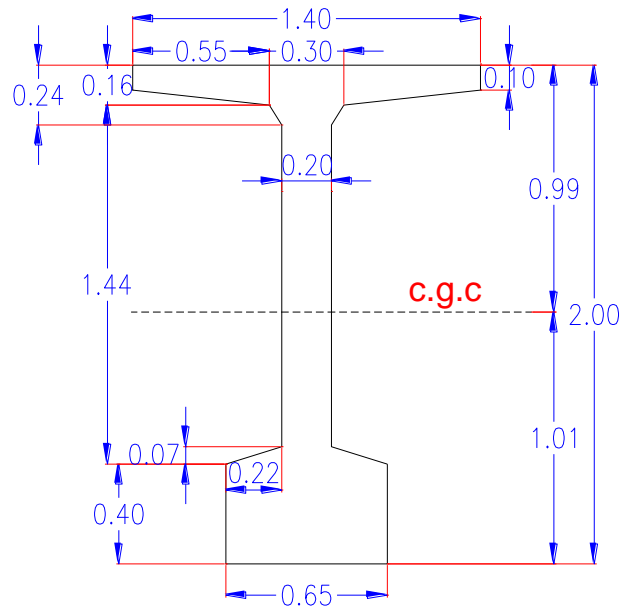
14 Sección típica de la viga preesforzada Bolt
